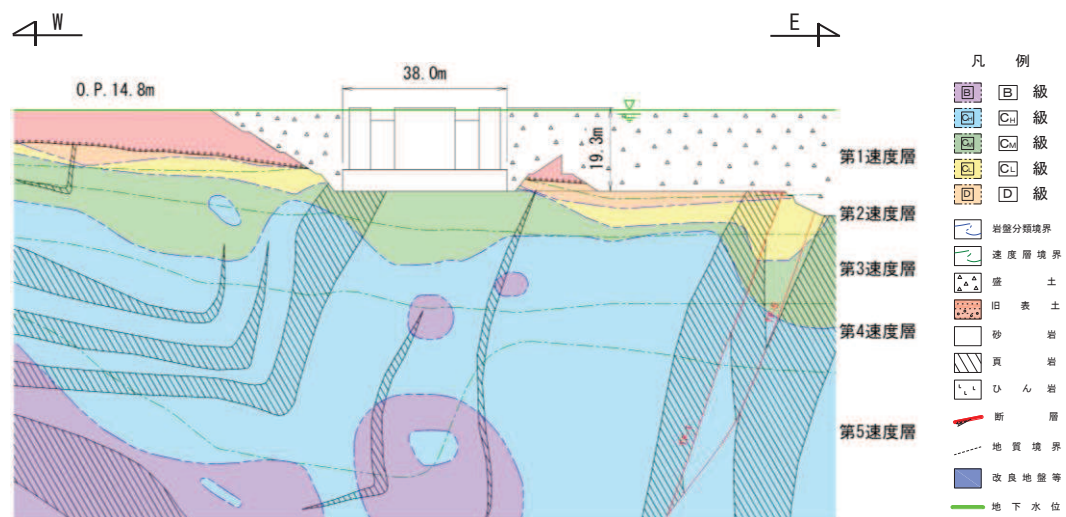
排気筒基礎 地震時荷重算出用地質断面图 (EW 断面)
